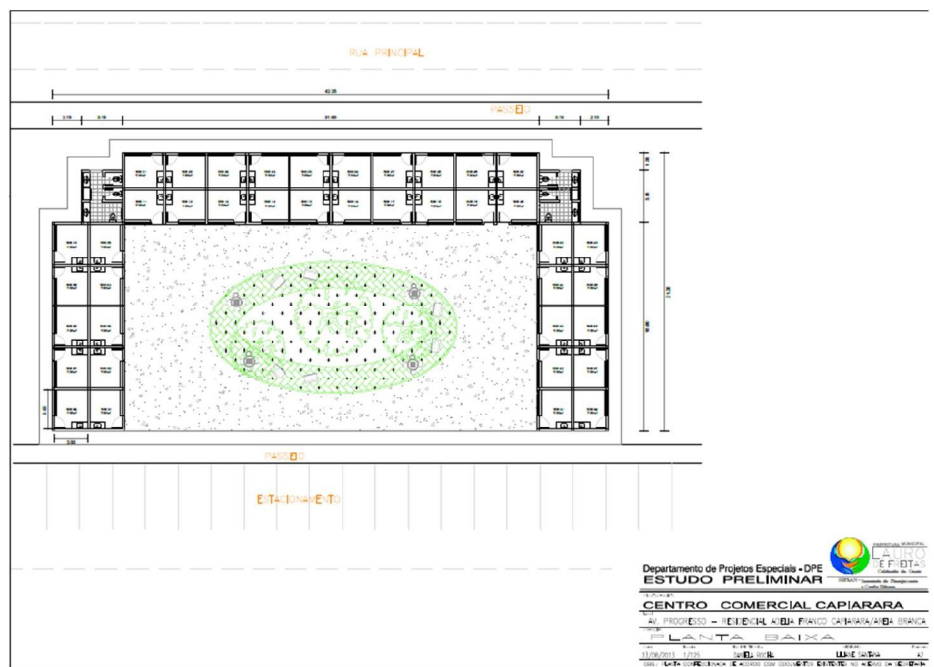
Planta baixa do Centro Comercial Capiarara – opção 1.
